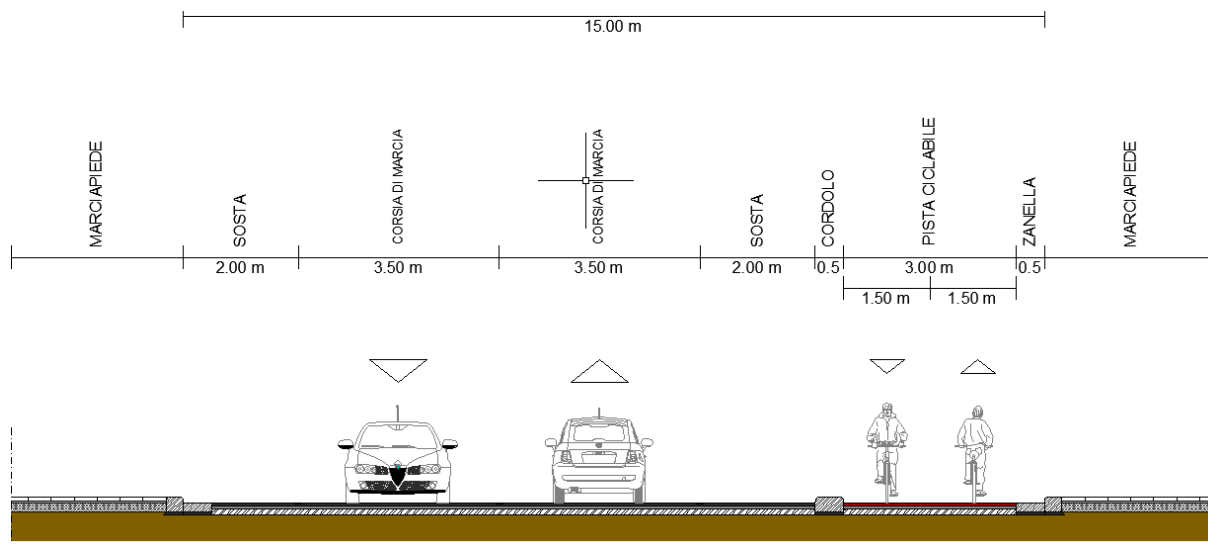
via Servio Tullio, sezione trasversale di progetto.
